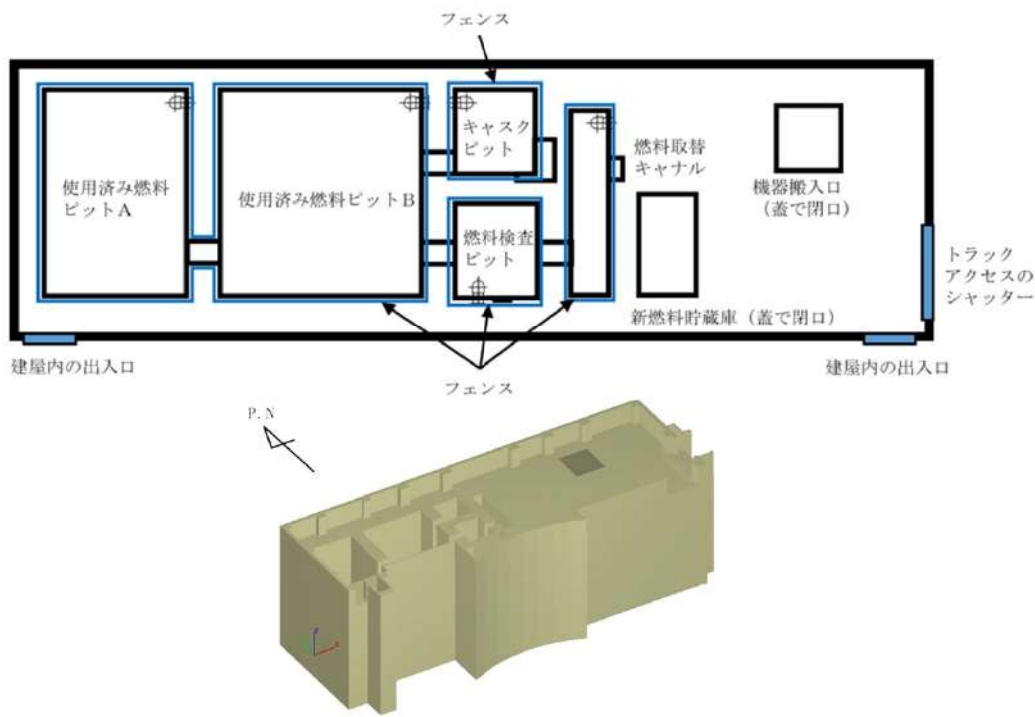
使用済燃料ピット周辺の機器配置図及び解析モデル図
